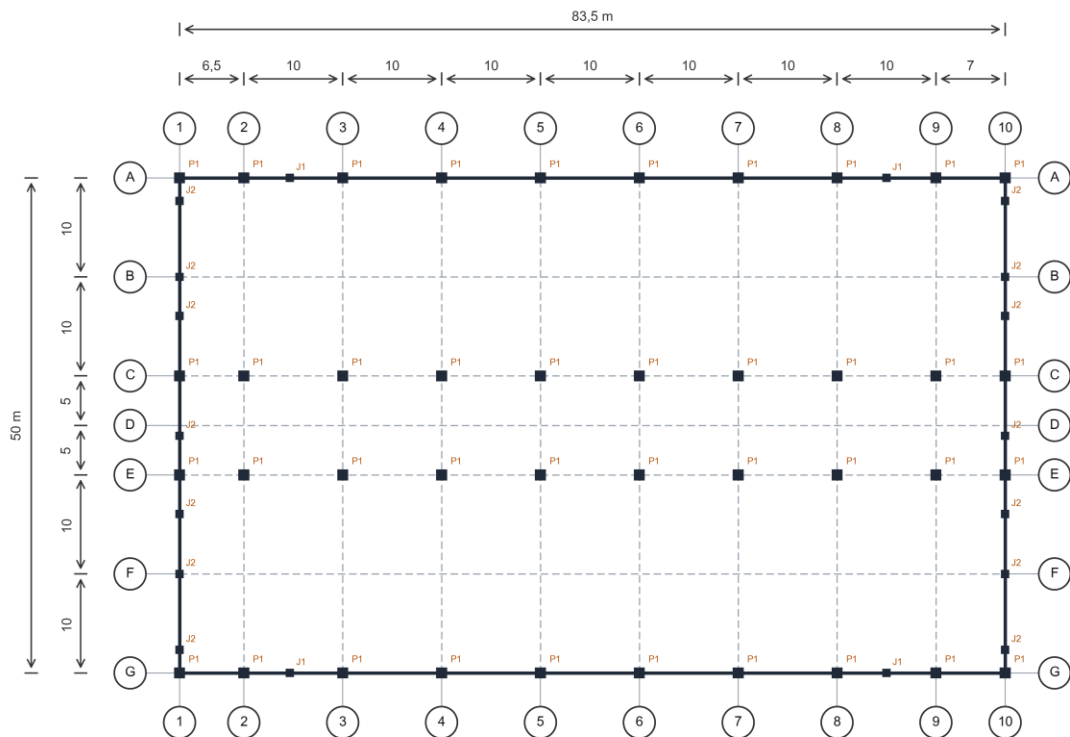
Planta de ejes y pilares de la Nave F con dimensiones.
